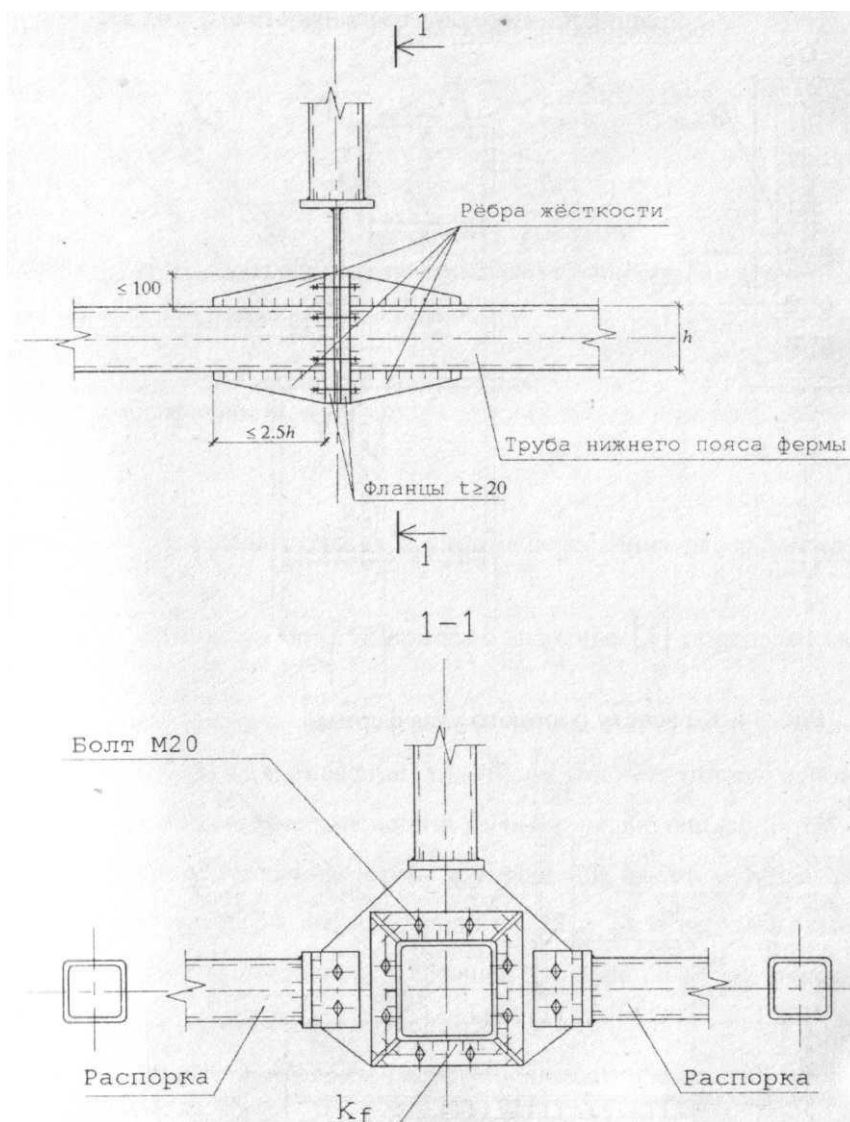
К расчету монтажного стыка нижнего пояса фермы из труб
